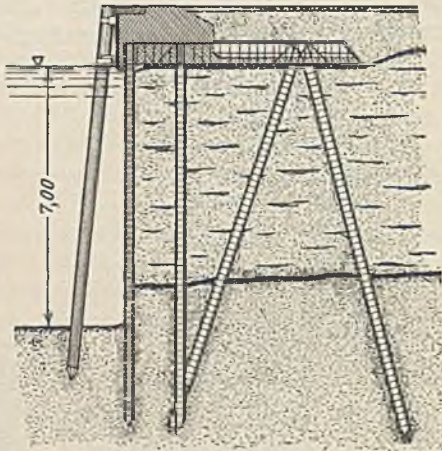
Eisenbeton Ufermauer im Stettiner Hafen.
